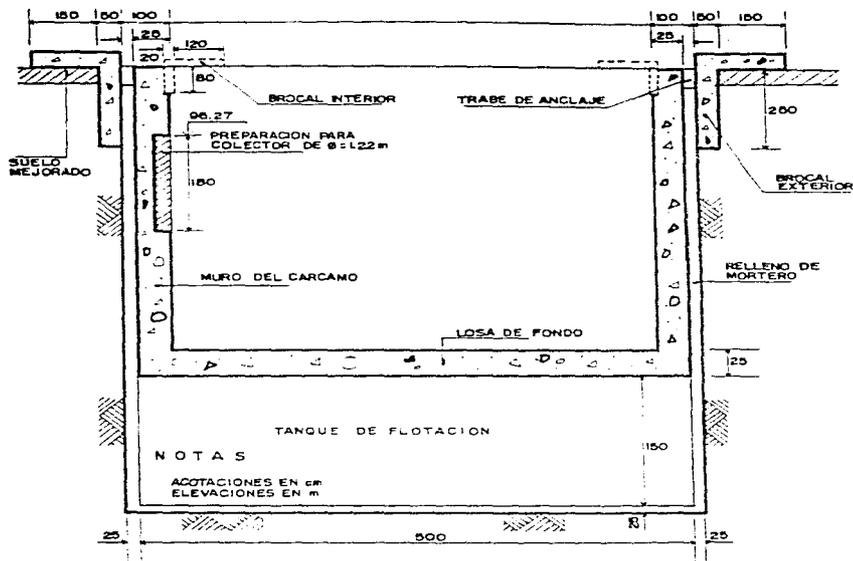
DETALLE DE CONSTRUCCION DEL CARCAMO DE BOMBEO
